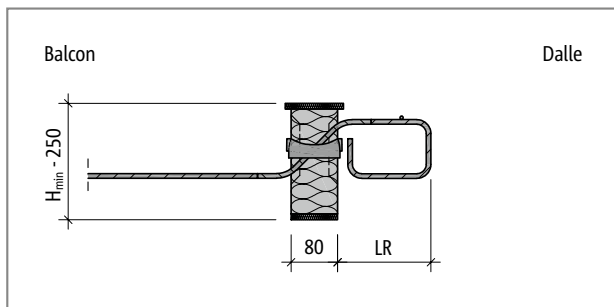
Schöck Isokorb® Type Q-E-W : Coupe du produit, affichage de la longueur d'installation LR
